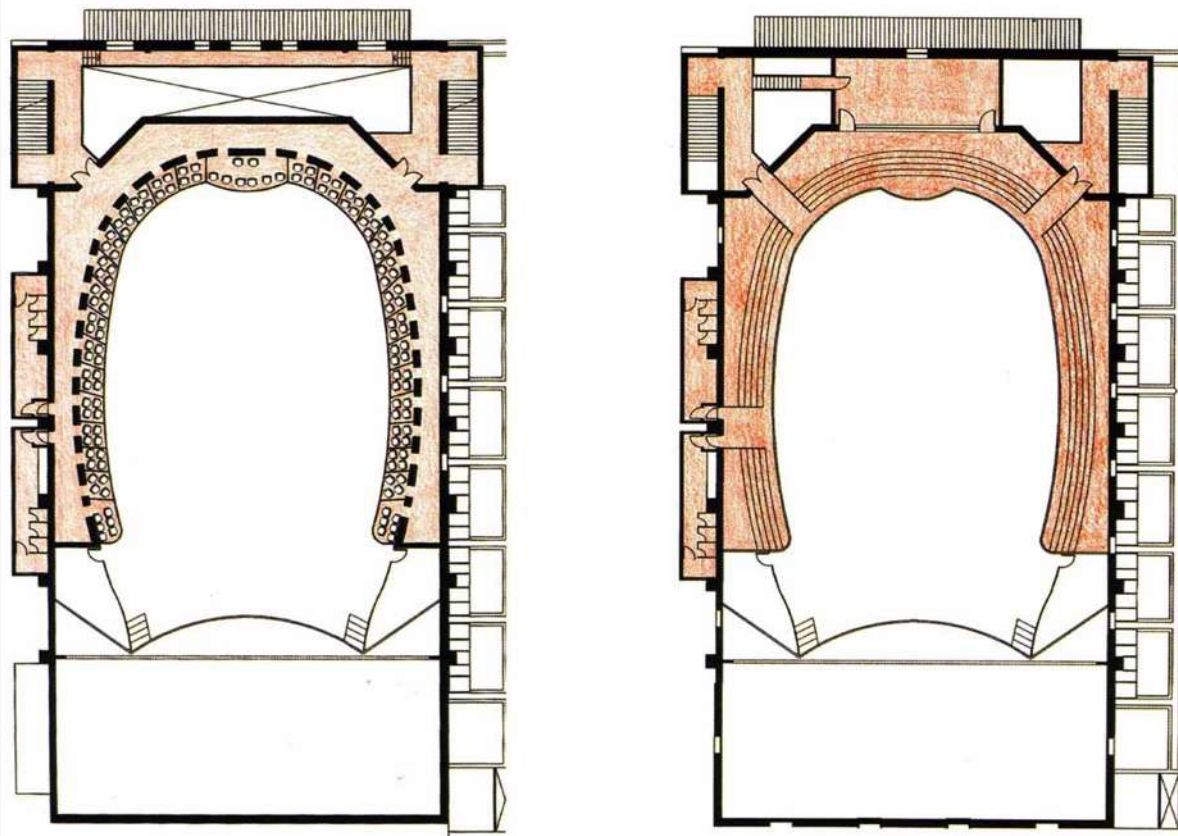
Plantas das frisas e arquibancadas – proposta de intervenção.
